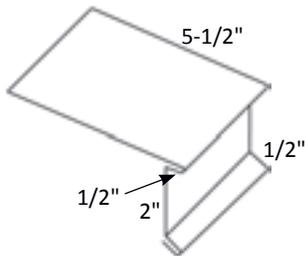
Las dimensiones del tapajuntas de borde de alero abierto (Open Rake Flashing)
